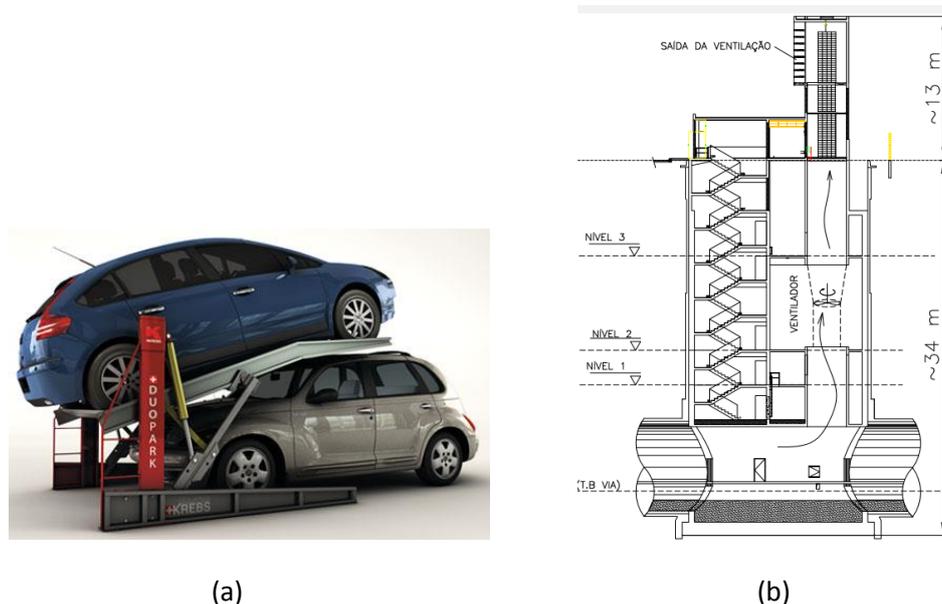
Exemplos de equipamentos fixos leve e pesado: (a) duplicador de vagas usado em garagens subterrâneas (fonte: <http://www.duopark.com.br/>); (b) equipamento utilizado em poço de ventilação de um túnel metroviário;
